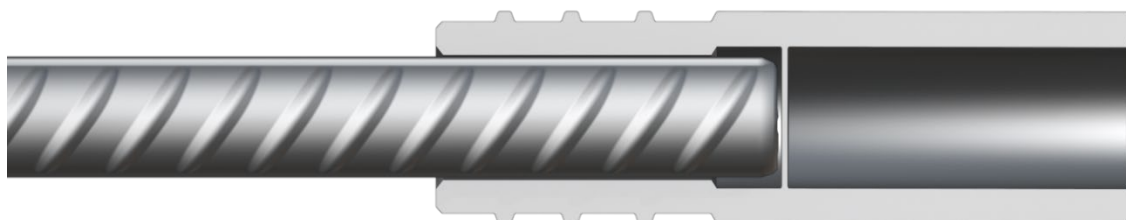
Опрессованный стык, обжатый с одной стороны
